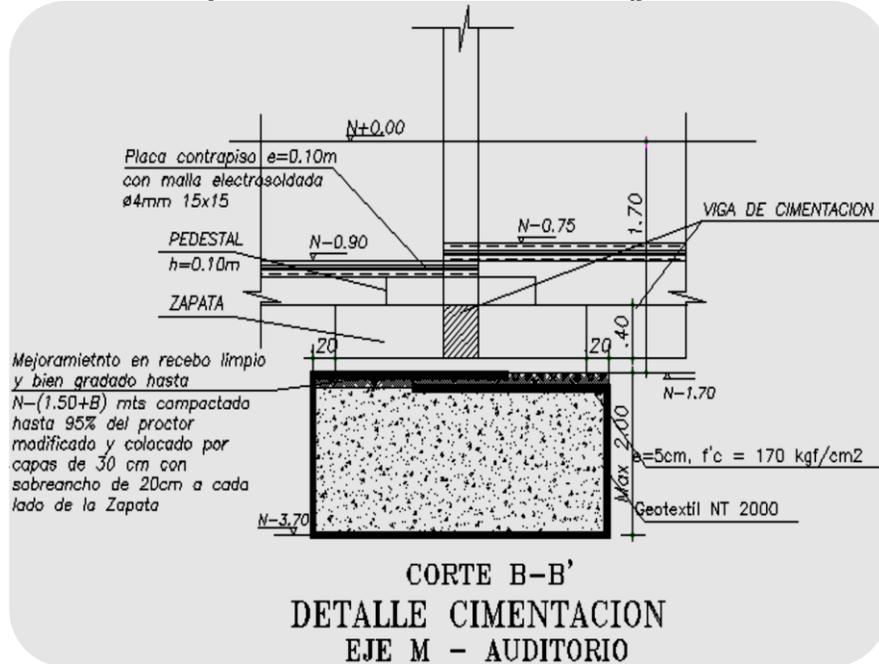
Corte 1 para detalle de cimentacion(planos cimentacion).
